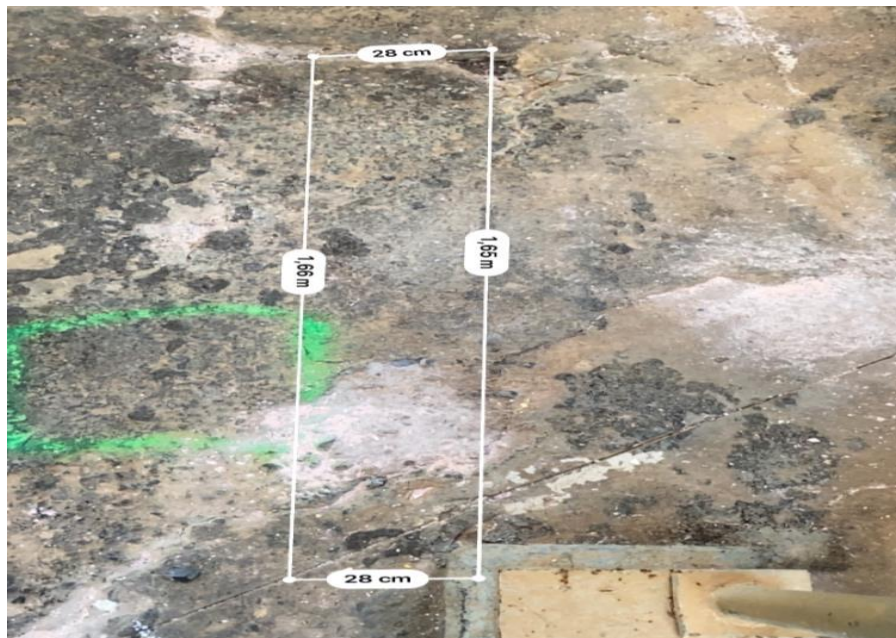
Vista de campo*4.2.2. Proposición de Alternativas de Tuberías y Accesorios para el Alineamiento
